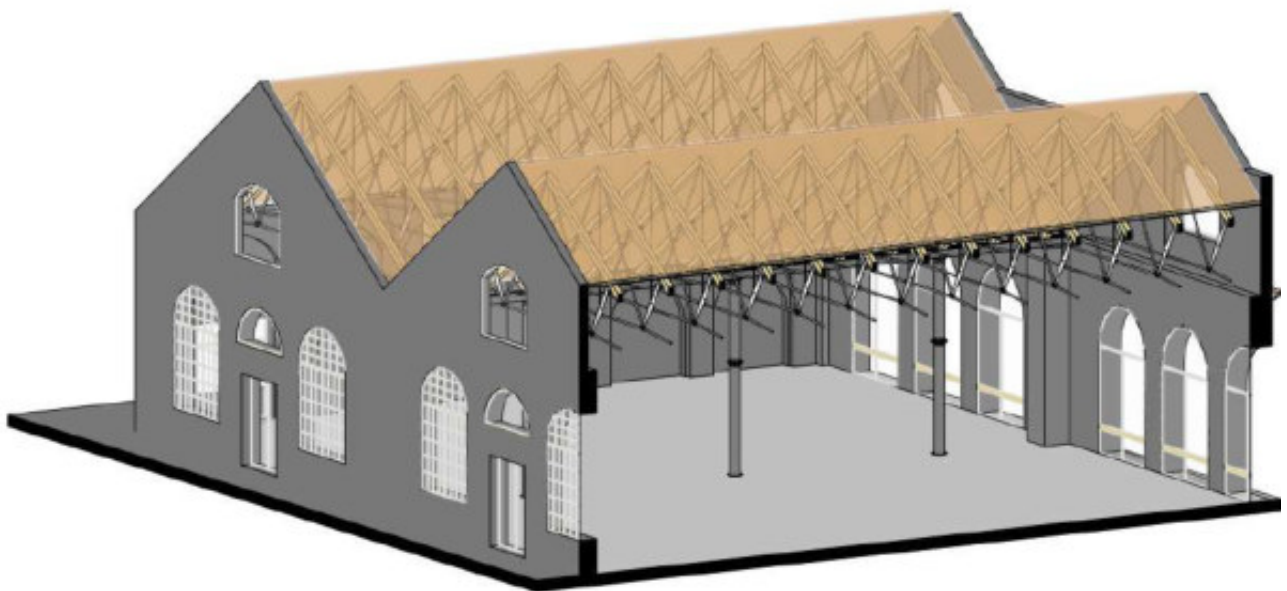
Edificio 8, Capannone ex-fonderia getti. Sezione volumetrica longitudinale del modello informativo BIM del PFTE.
